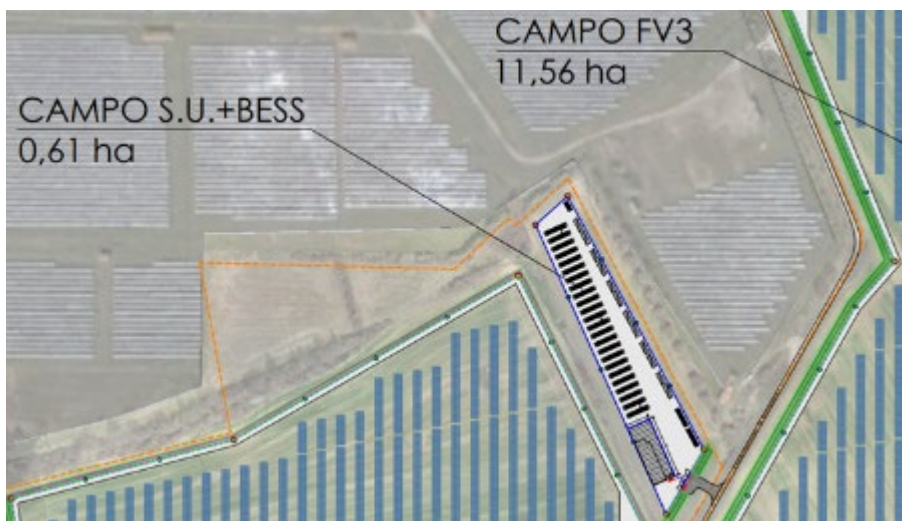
Planimetria del Campo “S.U.+BESS” – Dettaglio elaborato T2_02_Layout Layout generale di impianto
